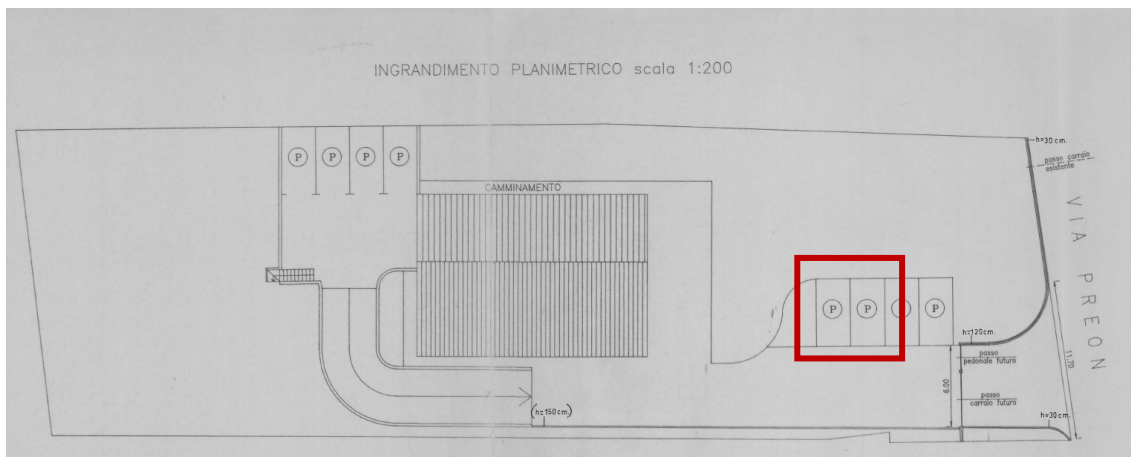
planimetria con individuazione corte esclusiva ad uso n. 2 posti auto
